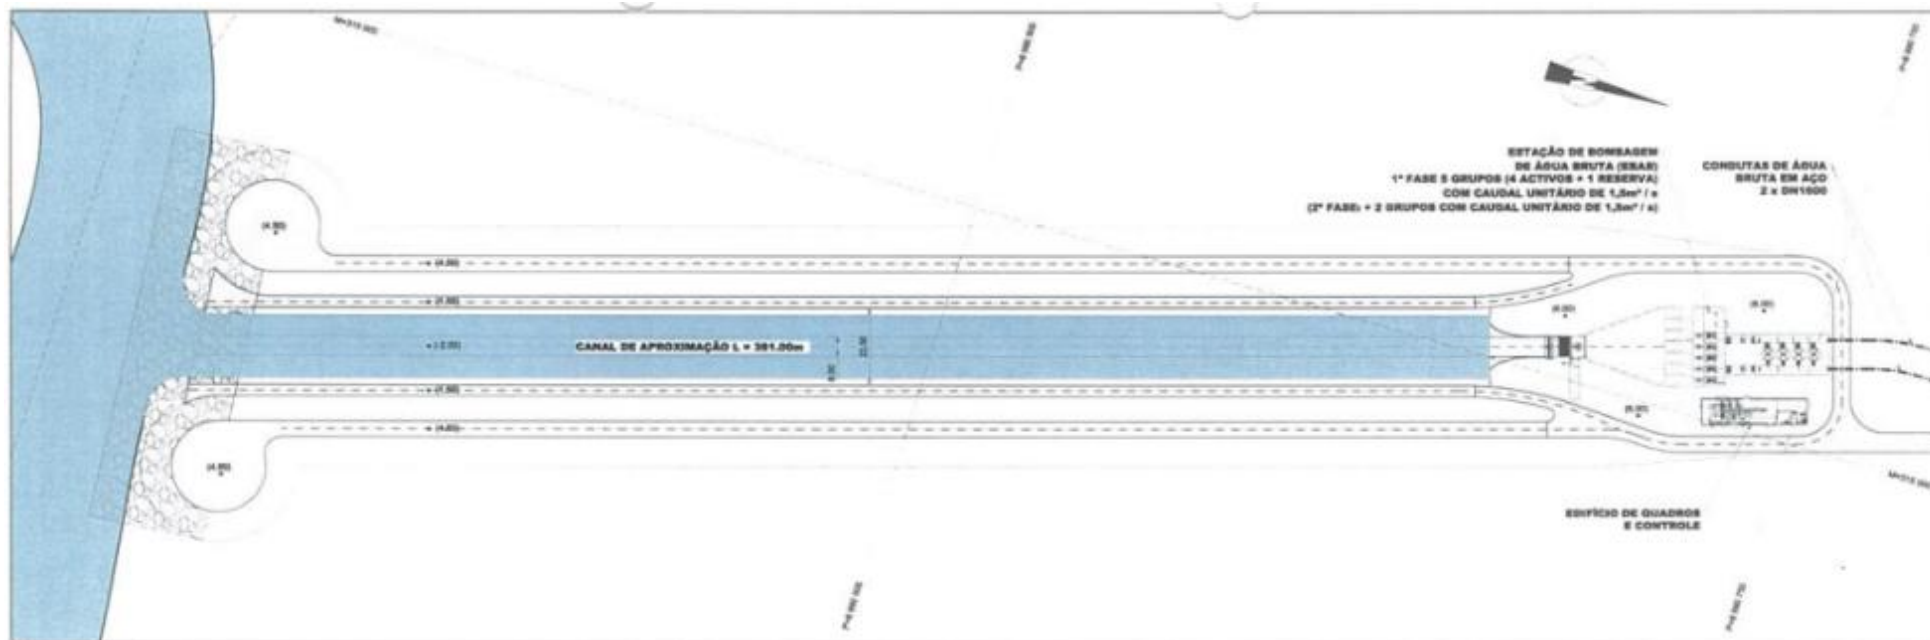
Traçado Geral das Obras de Captação do B4WSP
